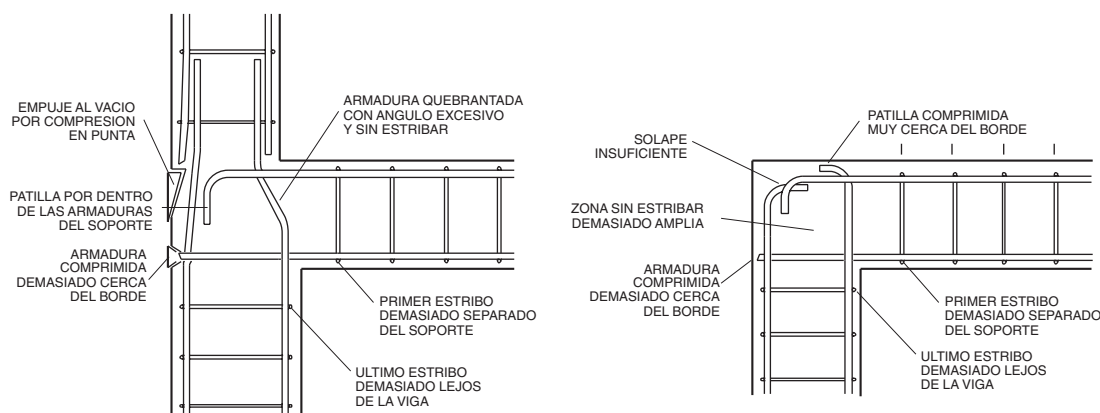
Precauciones en los encuentros de piezas de hormigón
